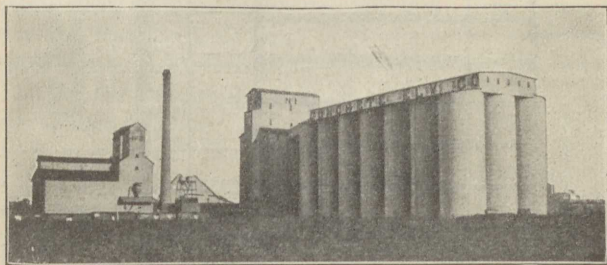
Betonsilo der Concrete Elevator Co. in Minneapolis. (Aus „Mühlen- und Speicherbau“.)
